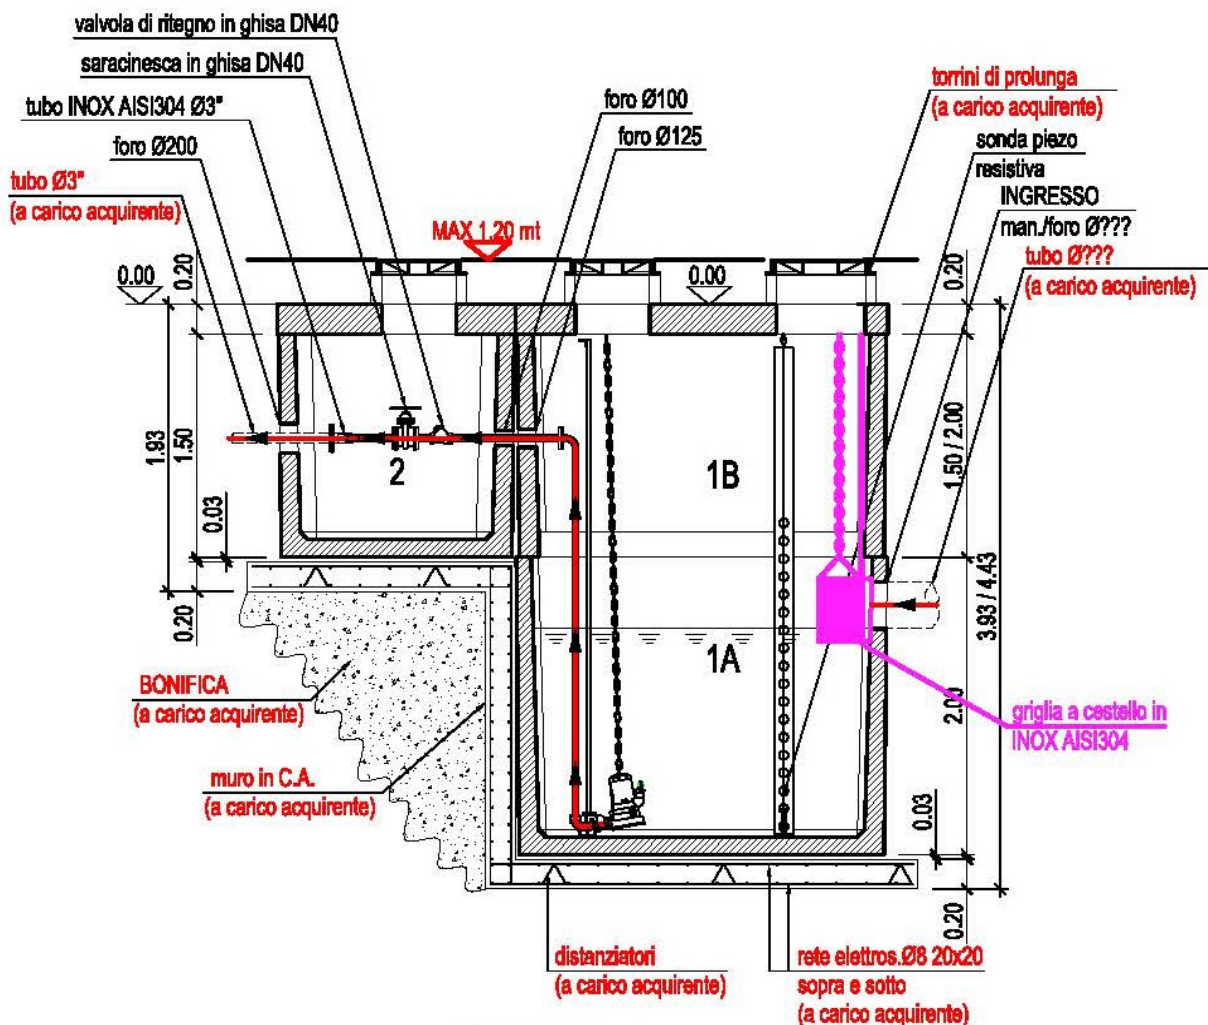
Sezione della vasca di accumulo e sollevamento prevista il progetto
